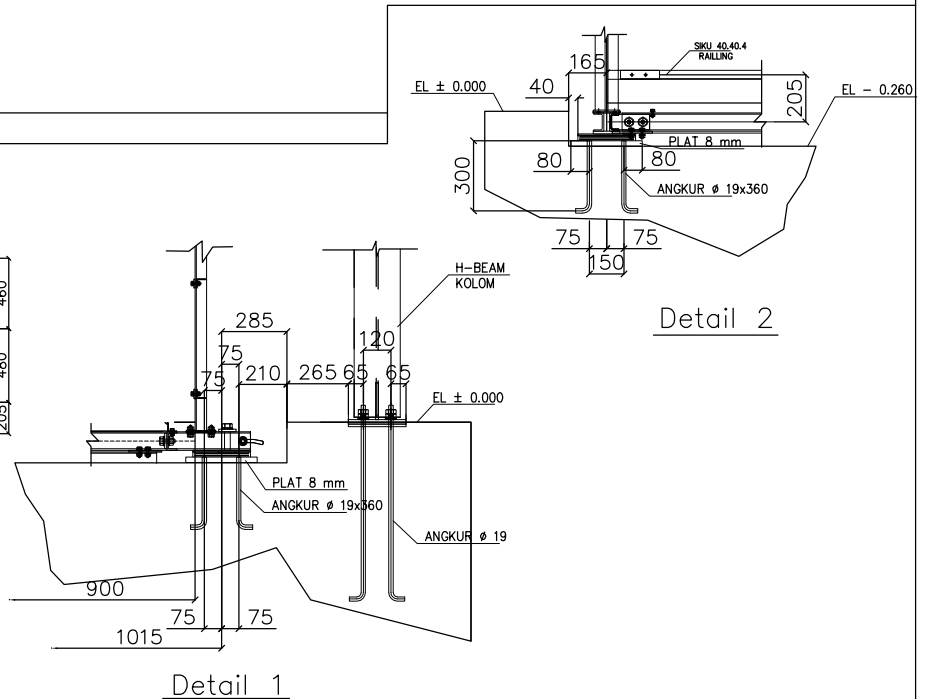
DETAIL DUDUKAN PILAR JEMBRAN GANTUNG BENTANG 42 M
